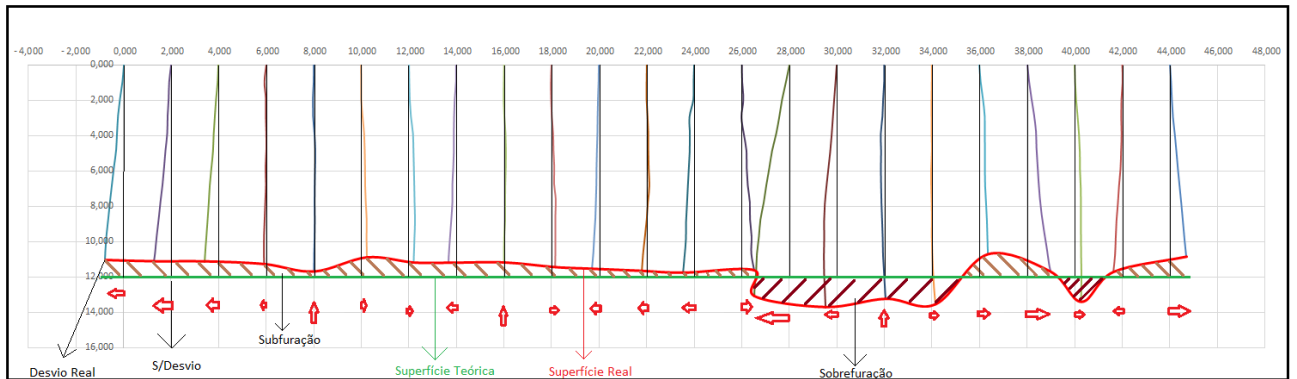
Disposição em planta lateral dos furos da 1ª fiada de P1.
